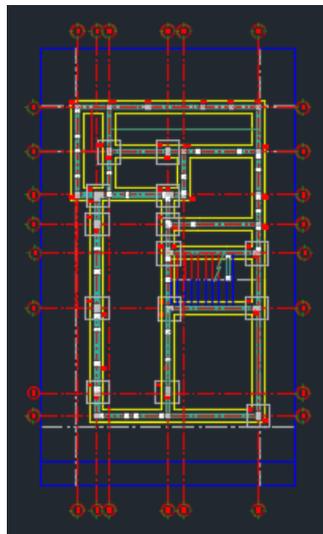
Plano de cimentación, zapata aislada y corrida.
